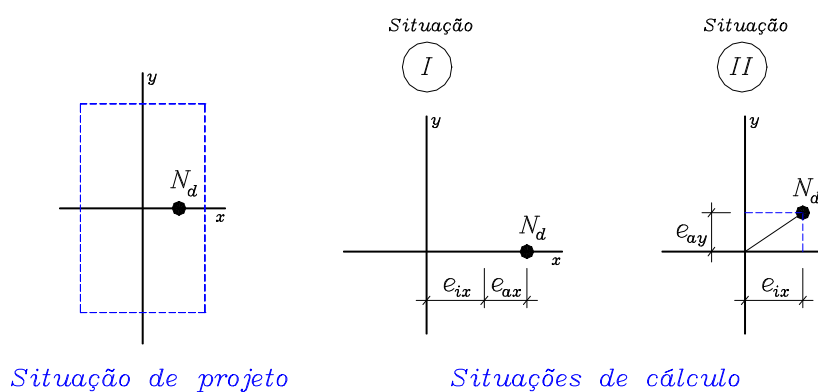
Situações de projeto e de cálculo para o pilar P2
